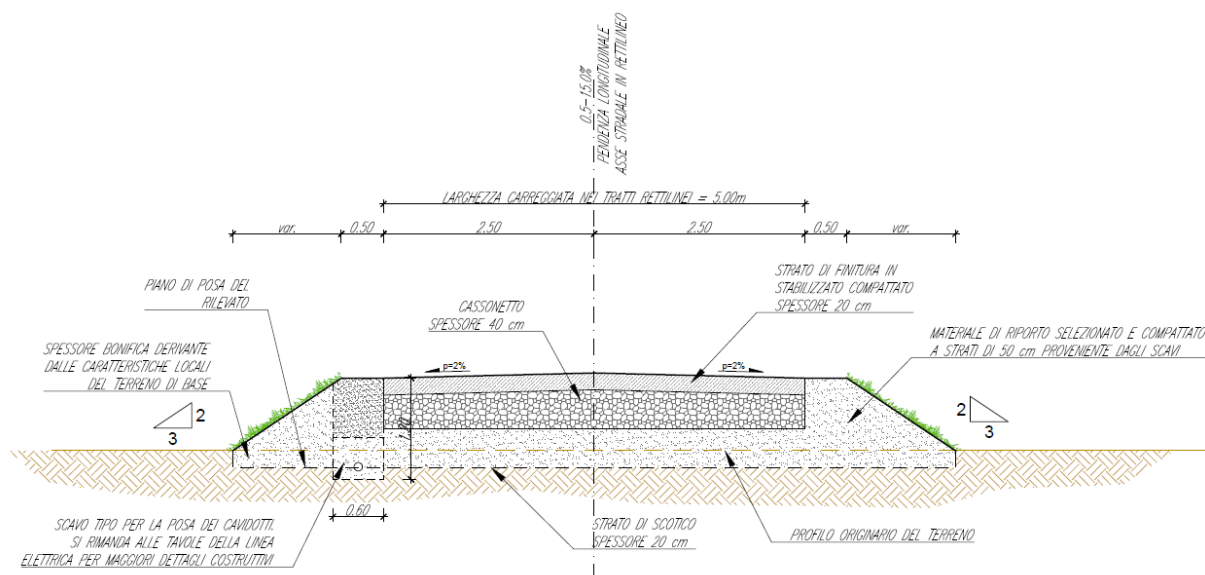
Sezione tipo rilevato stradale di altezza pari a circa 0,5 m – 1,5 m dove si prevede l'inerbimento delle scarpate.
